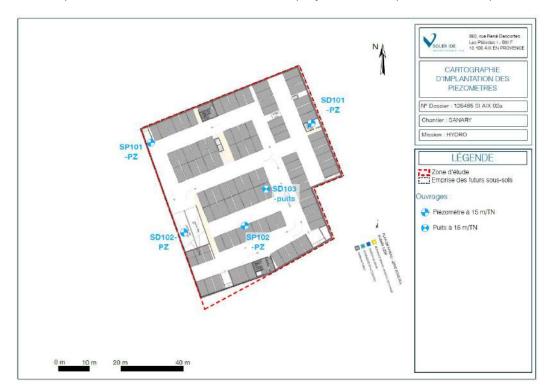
Plan d'implantation des piézomètres – Source : SOLER-IDE
